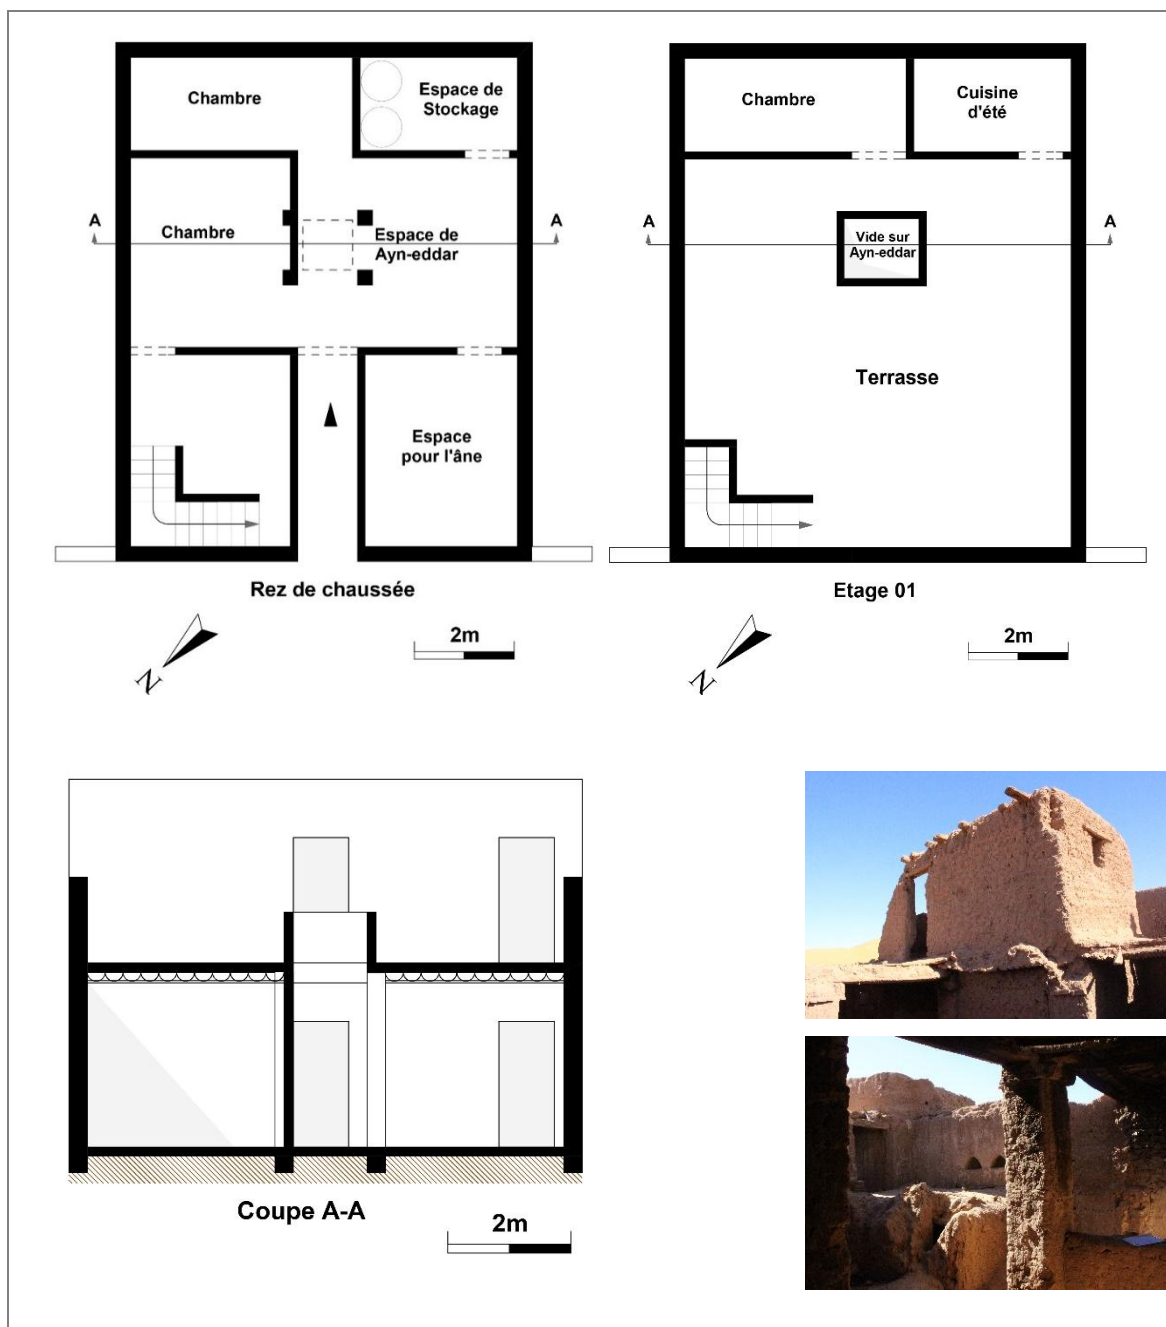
Plan et coupe d'une maison à *ayn-eddar*, ksar Taghit
